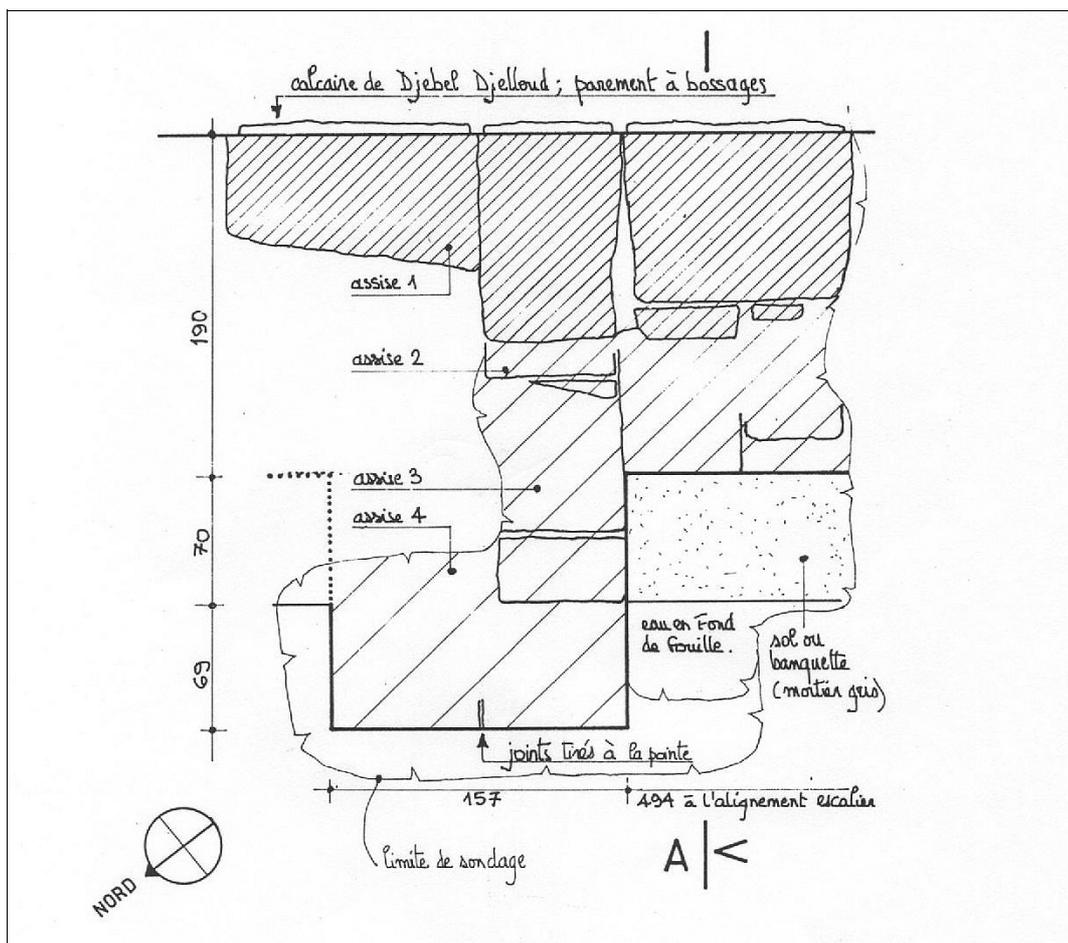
Relevés en secteur 1, sondage n°1 : plan de la façade du bord de mer.
